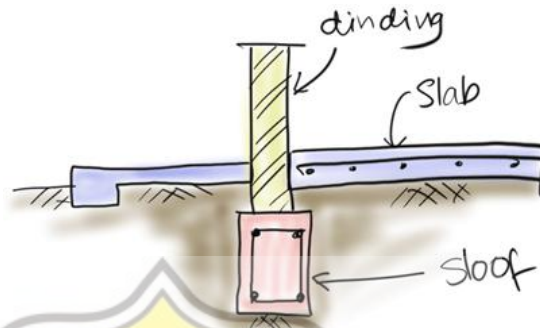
Contoh sloof sistem “*suspended slab*”
